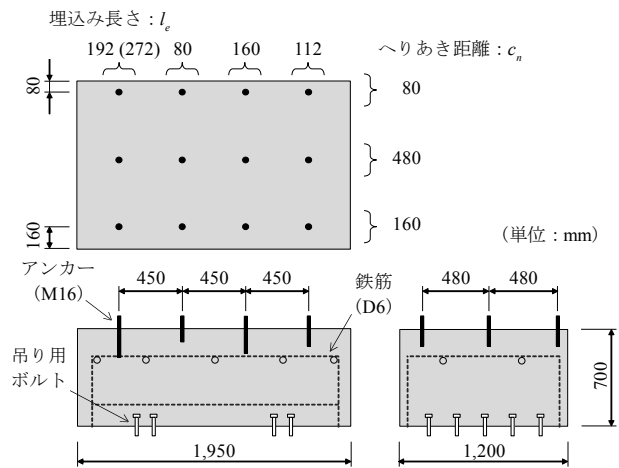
試験体の概要 (コンクリート塊, アンカー配置)
